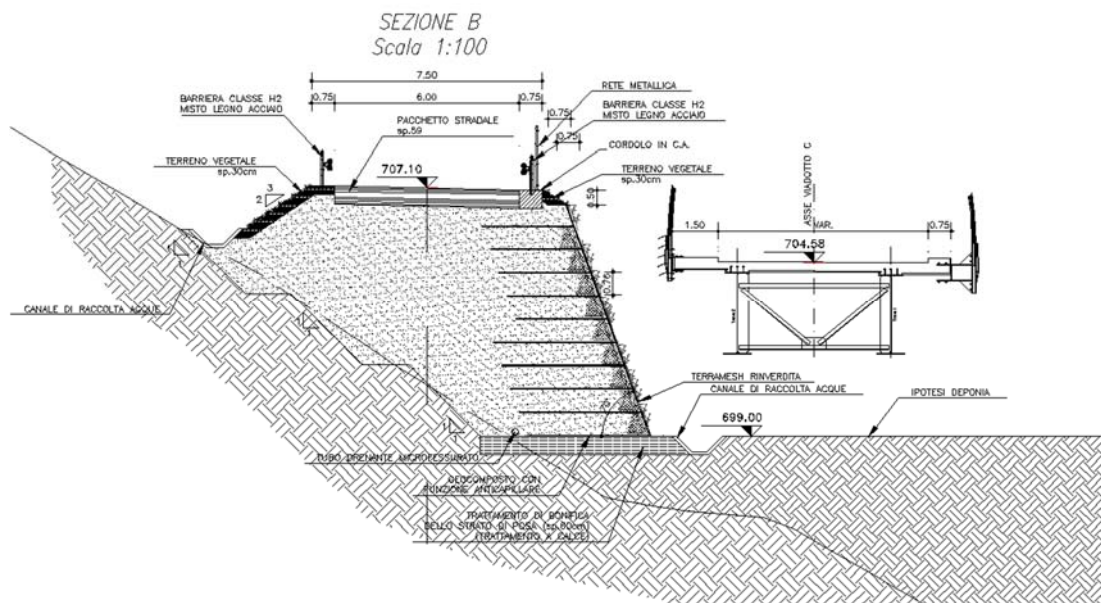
Sezione tipica berlinese viabilità collegamentoFigura 30 - Prospetto muri in terra mesh verdeFigura 31 - Sezione tipica muri in terra mesh verde
